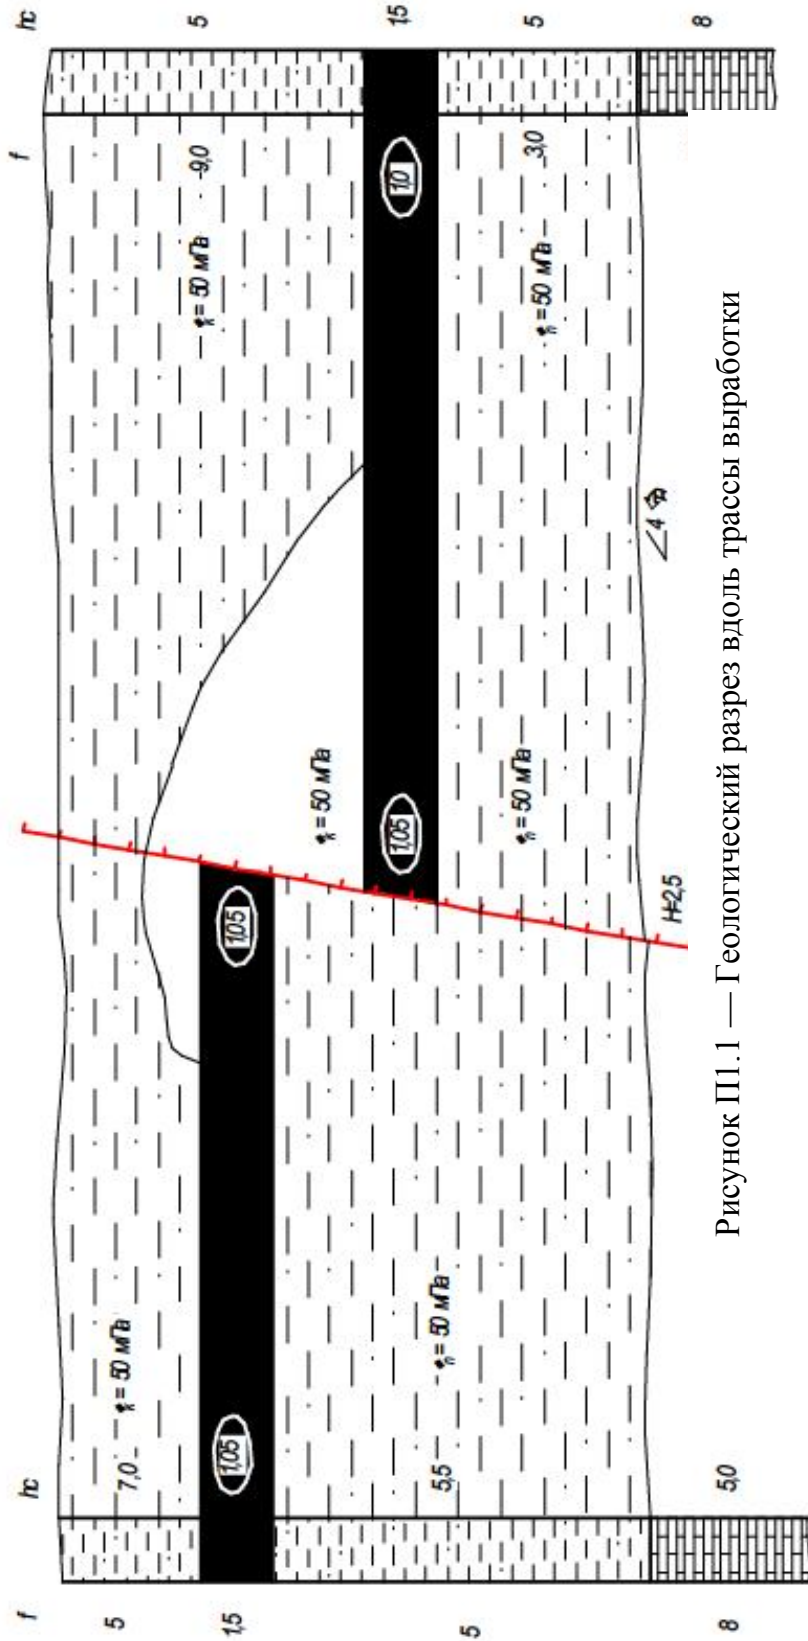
Геологический разрез вдоль трассы выработки
